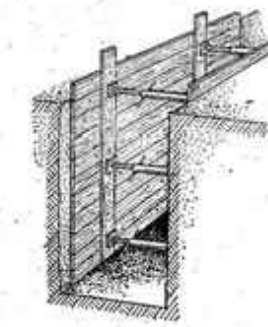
Щитовое крепление вертикальных стенок котлованов и траншей сплошными щитами с инвентарными распорками
